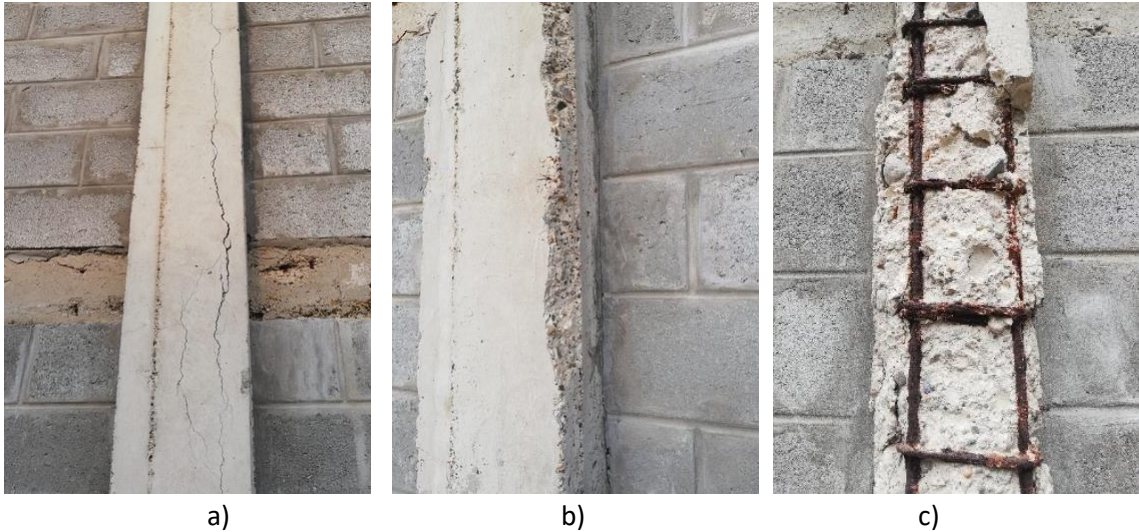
Columnas en el eje A y D: a) Fisuras de espesor de 1 a 4 mm b) Gran desconchado del hormigón. c) Armadura expuesta a la intemperie con pérdida de sección por corrosión.
